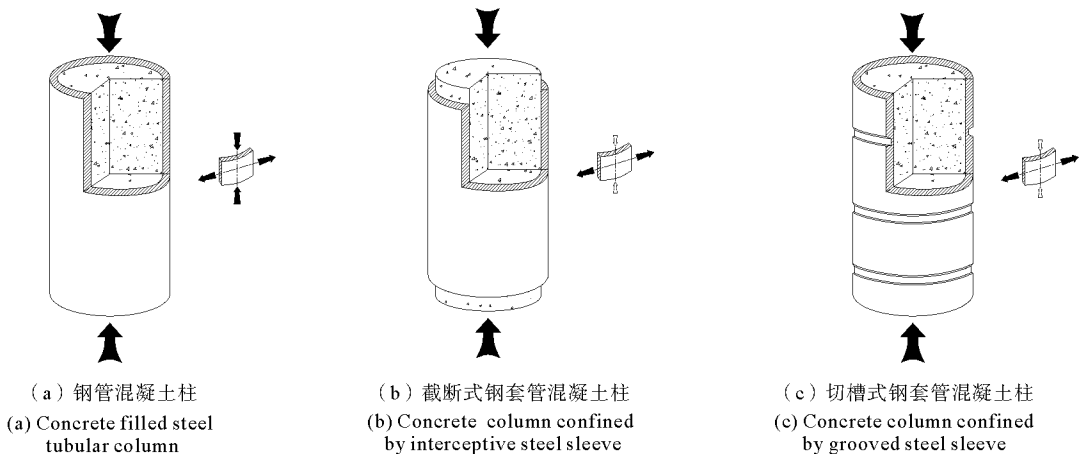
钢管混凝土柱与钢套管混凝土柱示意图
